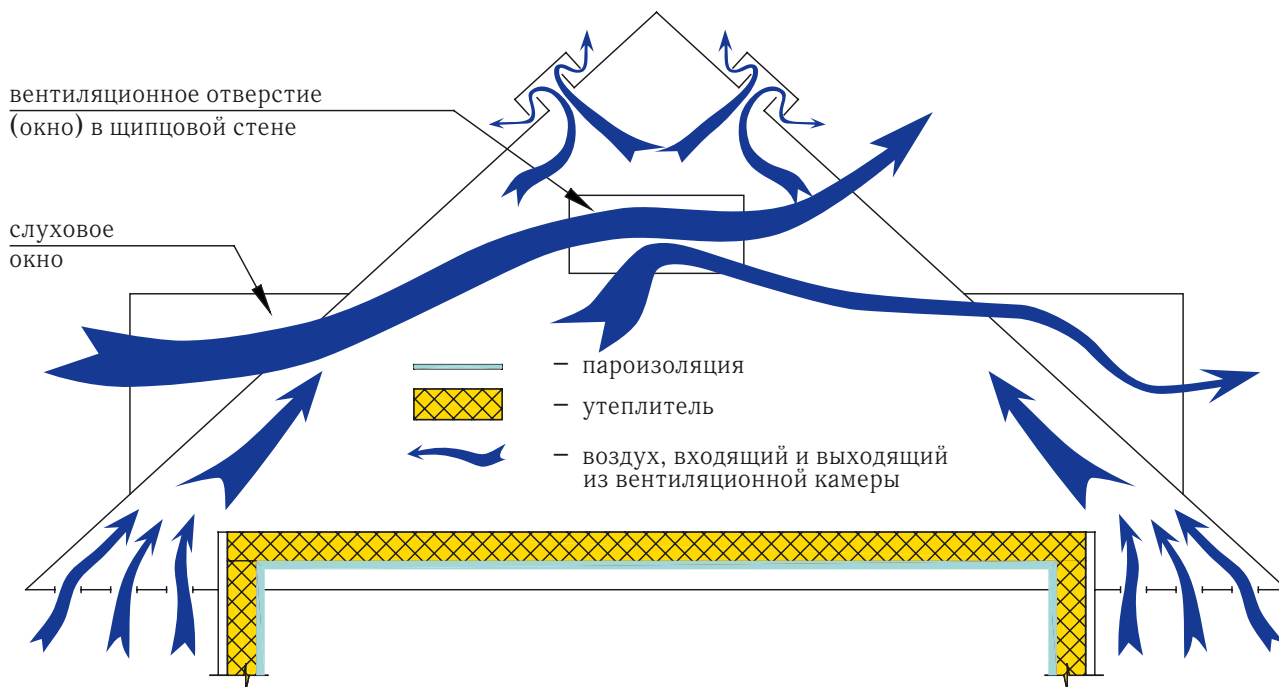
Схема утепления, пароизоляции и вентиляции нежилого чердачного помещения
